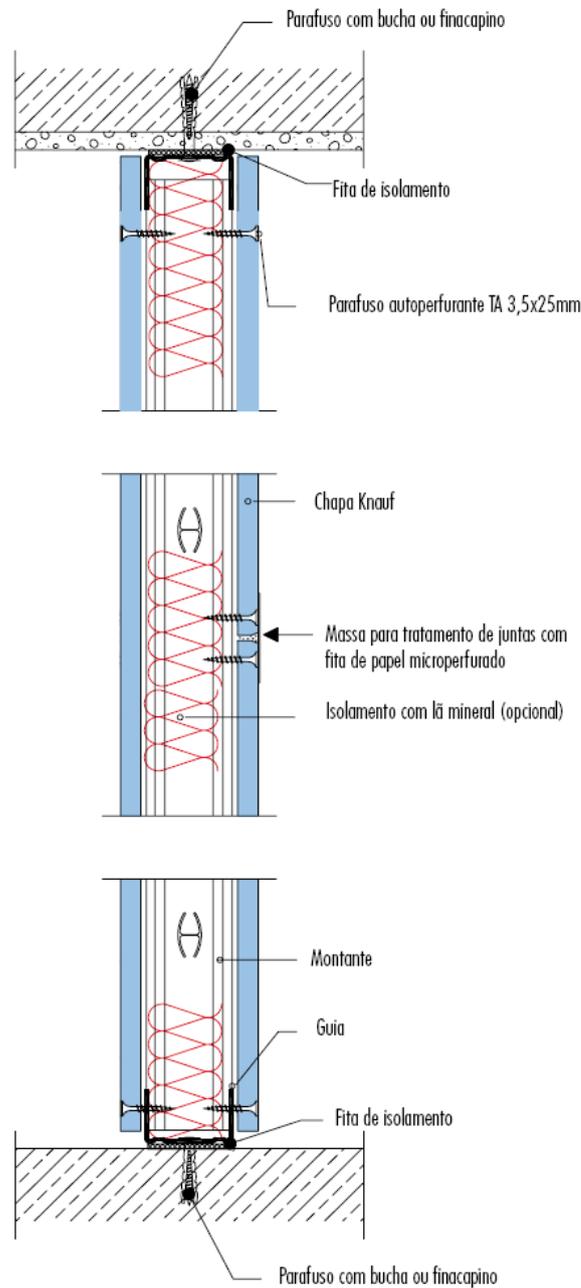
Detalhes técnicos da parede *Drywall*- Corte.
